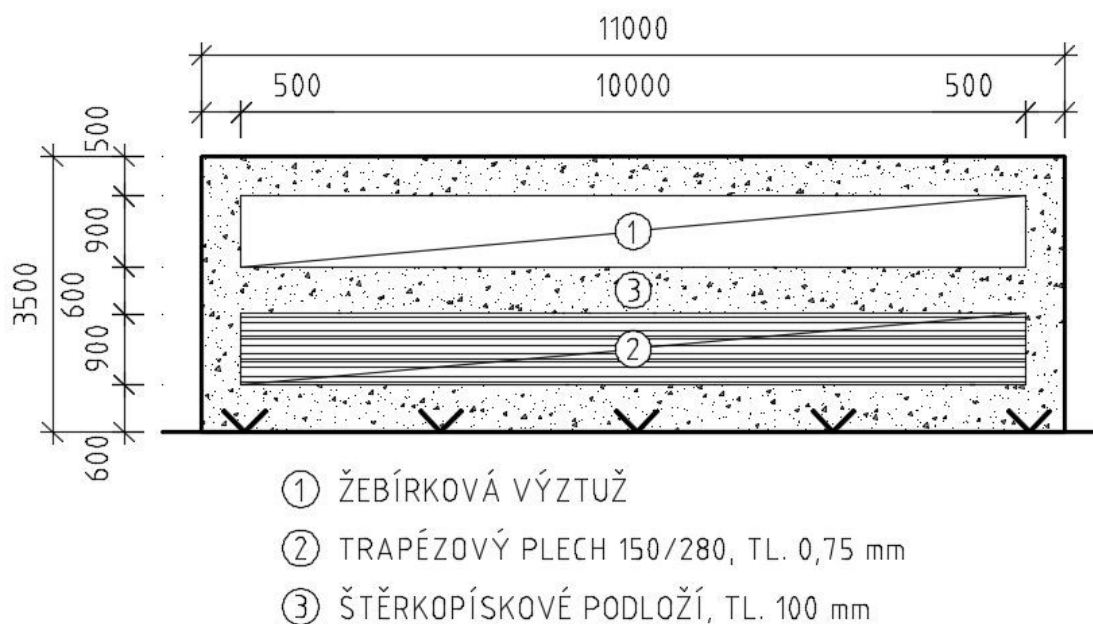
Půdorys Skladovacího kontejneru LK1
